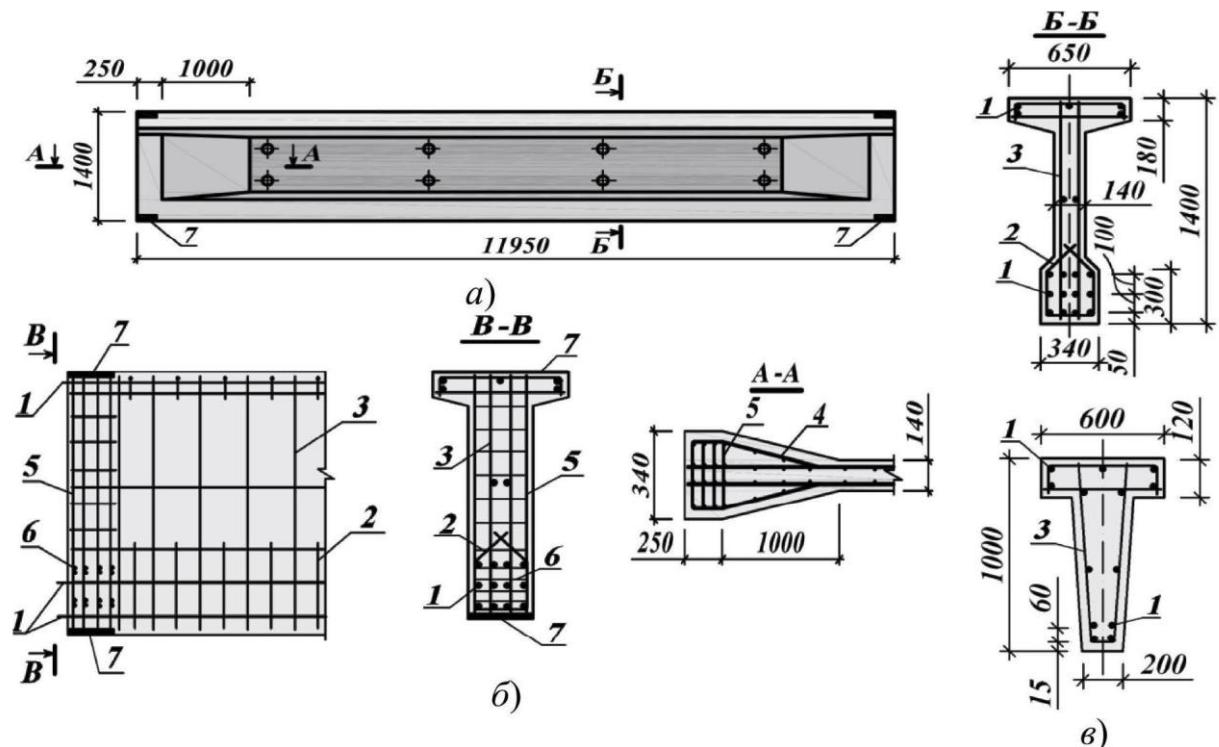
Залізобетонні збірні попередньо напружені підкранові балки: а – загальний вигляд балки прольотом 12 м; б– схеми армування опорної частини балки; в — поперечний переріз балки прольотом 6 м [6];
